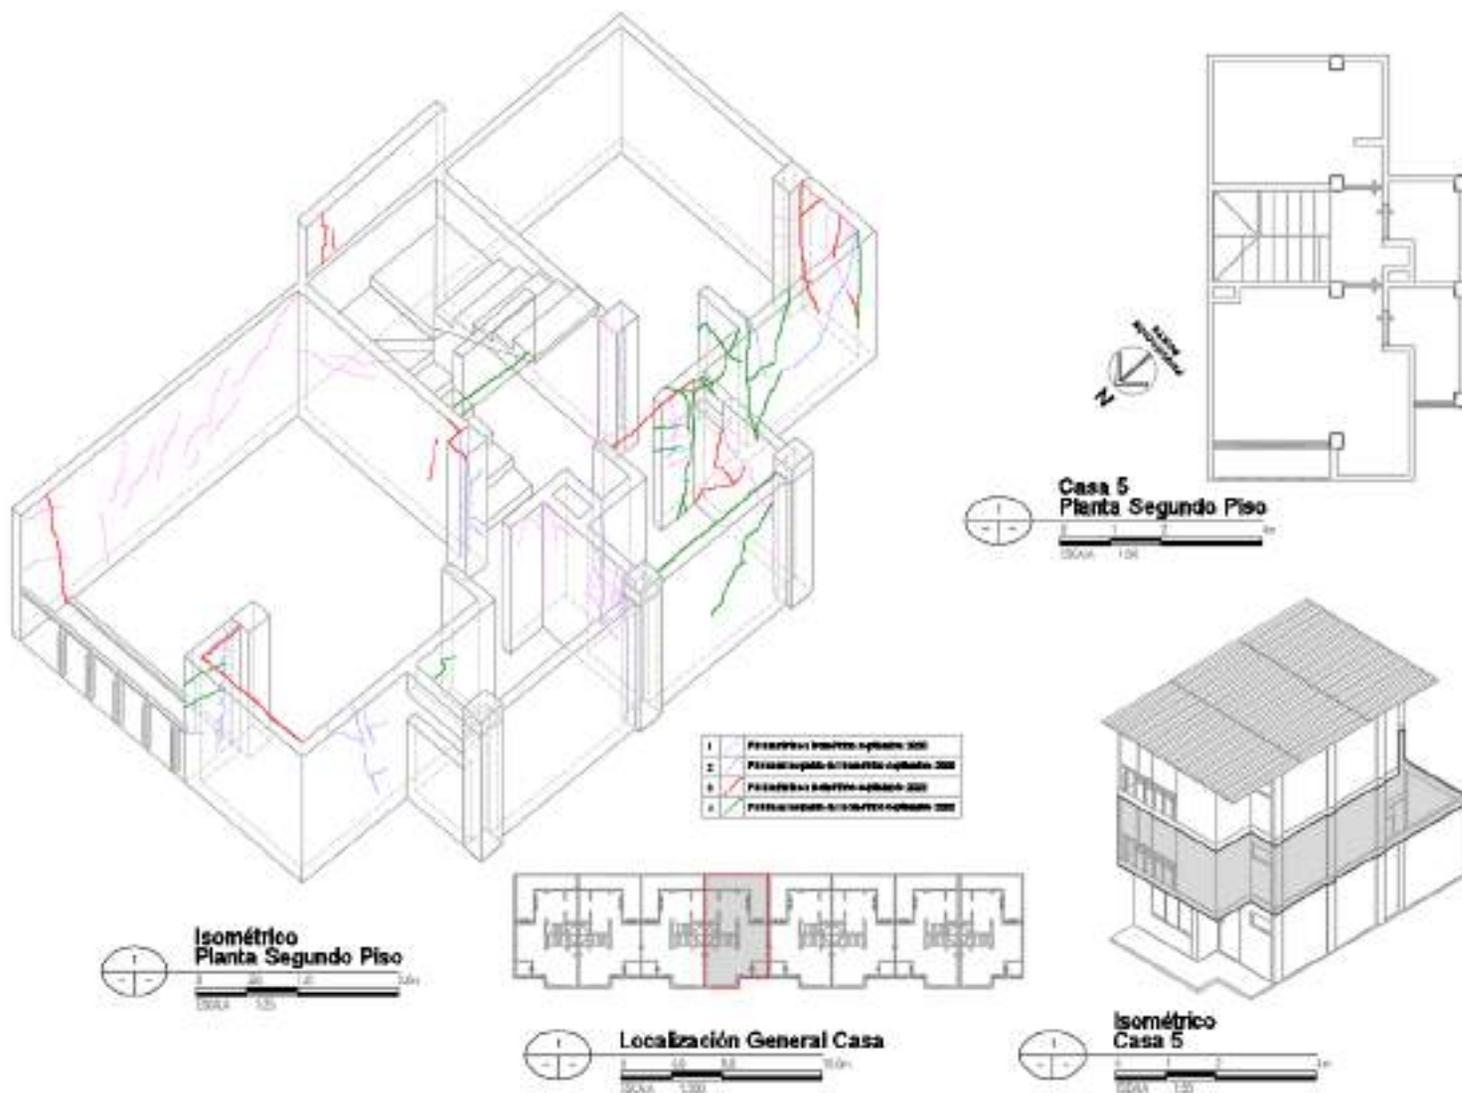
Levantamiento de daños segundo piso Casa No. 5.
